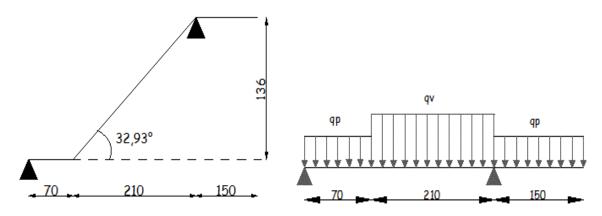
Schéma statique de la 1^{ére} la 3^{éme} volée.
